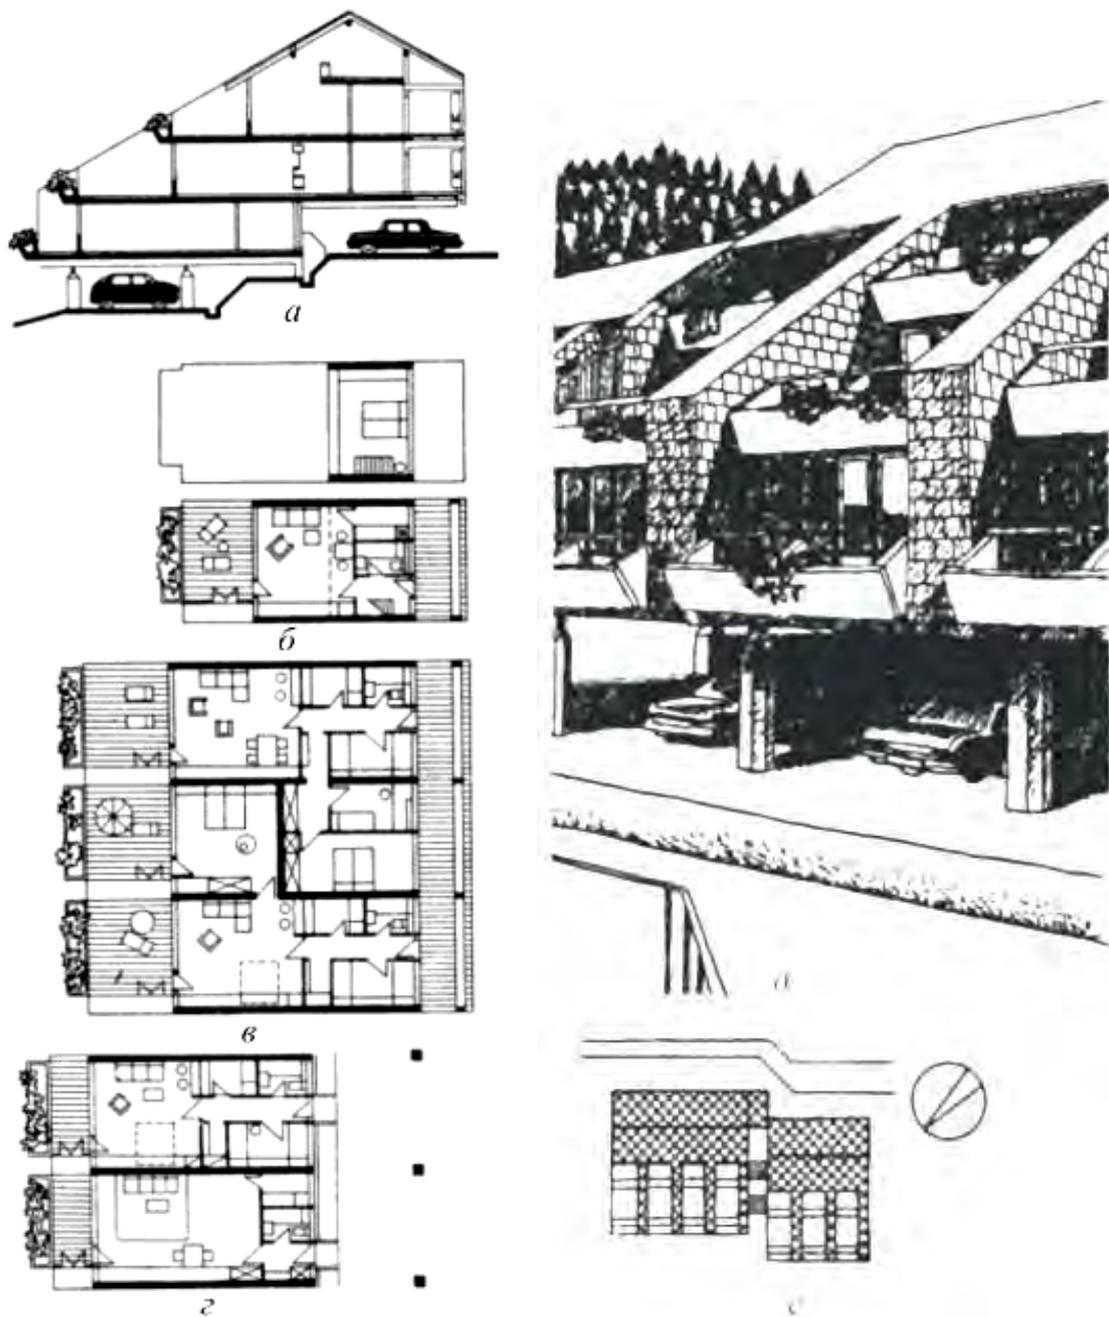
Террасный дом галерейного типа (ФРГ): *а* — разрез; *б* — планы верхней квартиры; *в* — план квартир второго этажа; *г* — варианты планировки квартир первого этажа; *д* — фрагмент фасада дома; *е* — план дома
